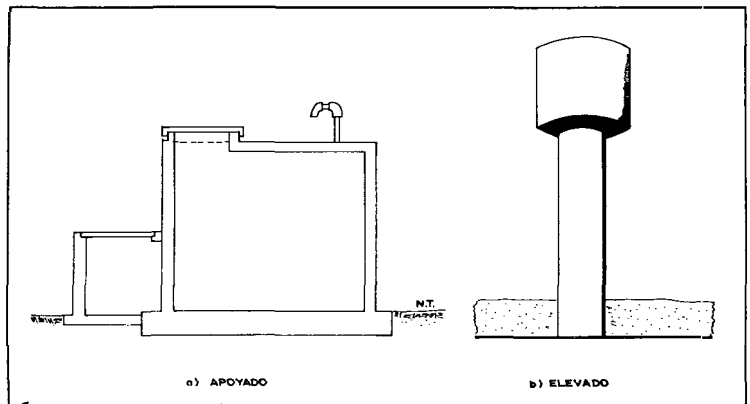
Tipos de reservorios: apoyado y elevado
